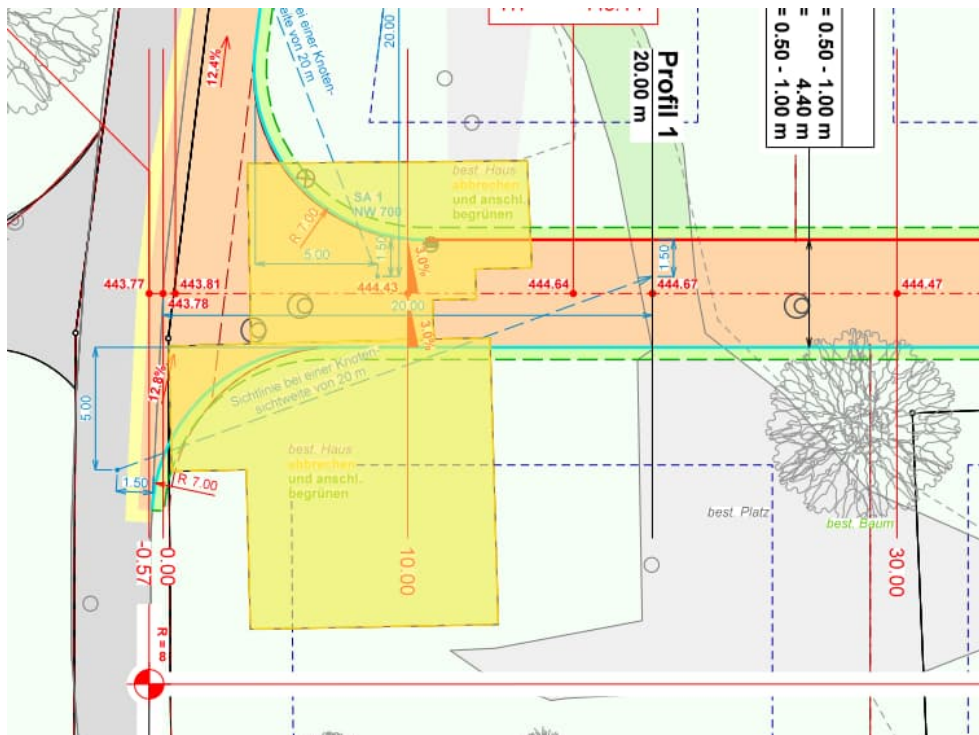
Ausschnitt Situation Strasse, Plan Nr. 1331 03.04-1
